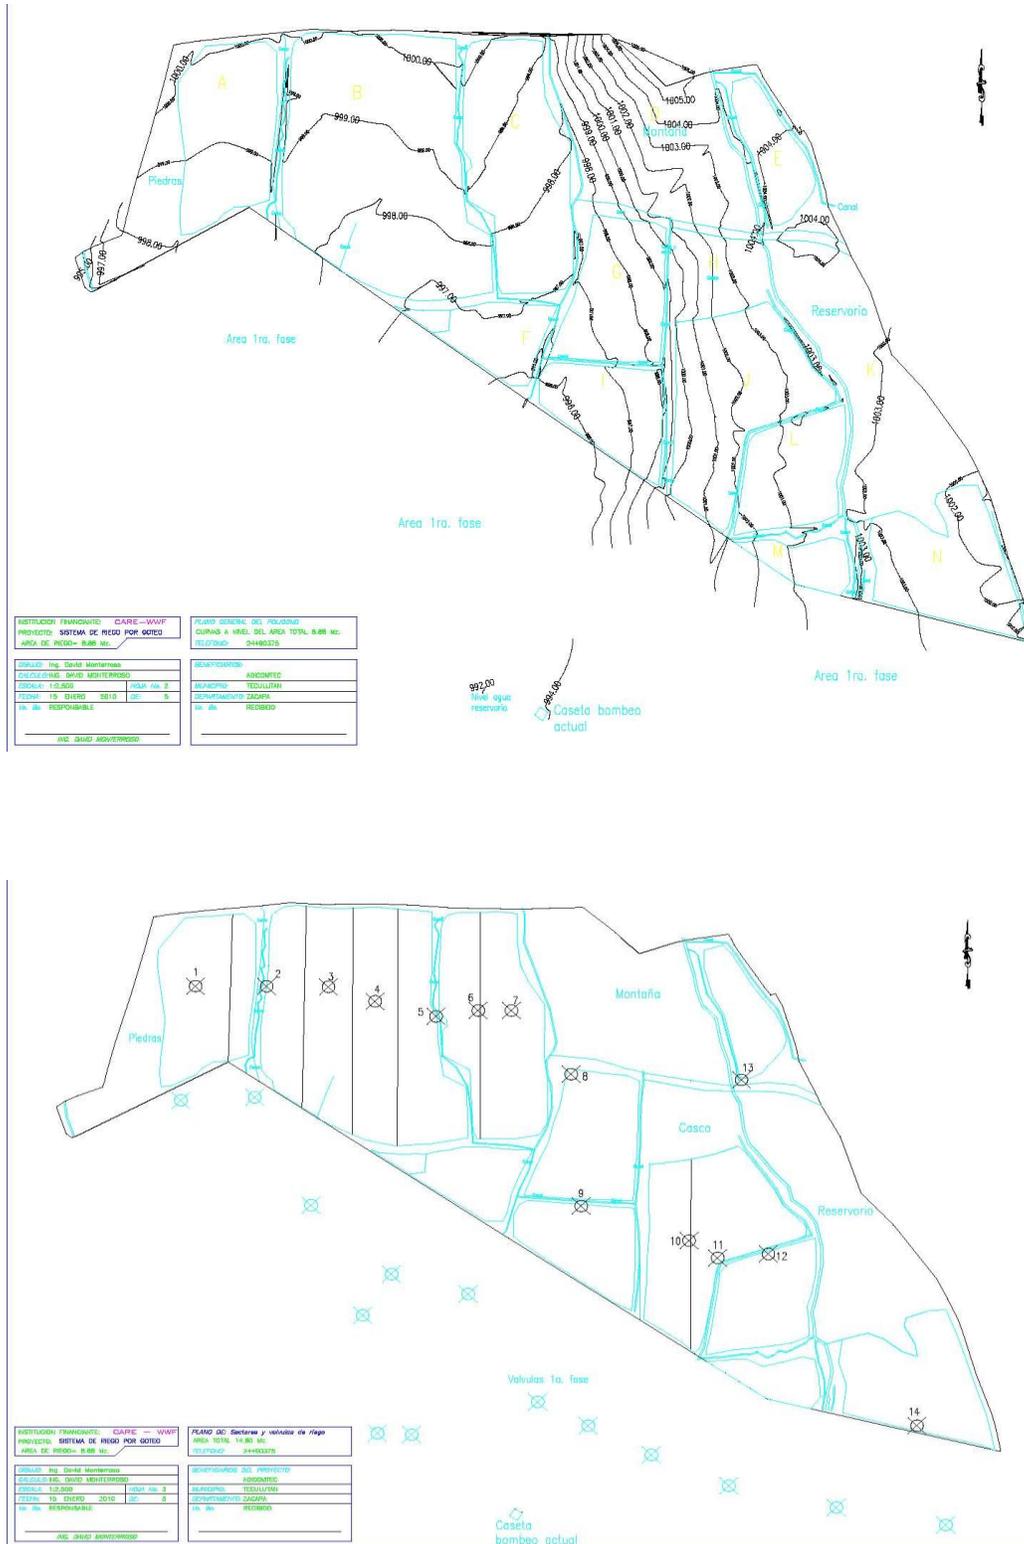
Planos para la construcción e implementación del sistema de riego por goteo
